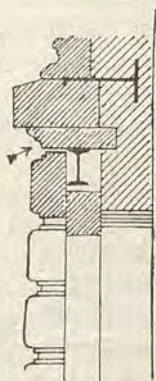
Modo di scaricare un architrave di pietra sopra una apertura.
